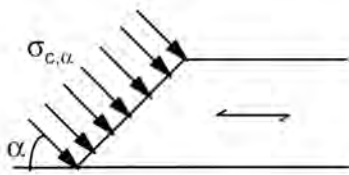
Spannungen unter einem Winkel zur Faserrichtung
